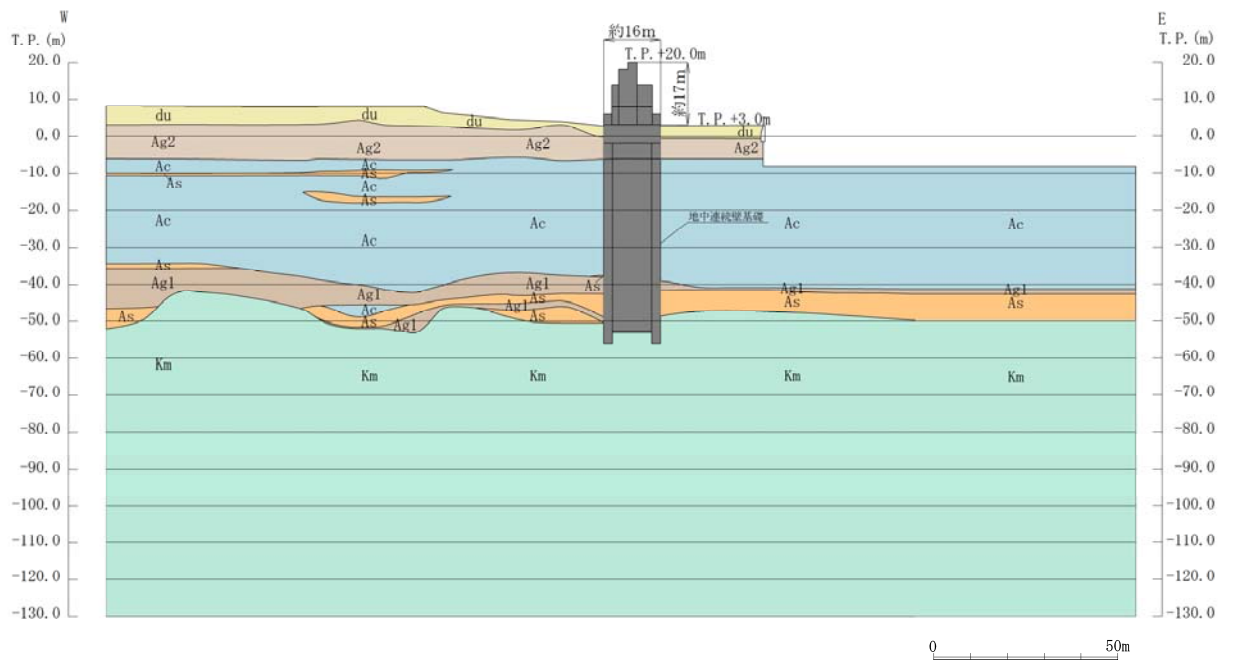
(2) 鋼製防護壁断面図 (②-②断面)
